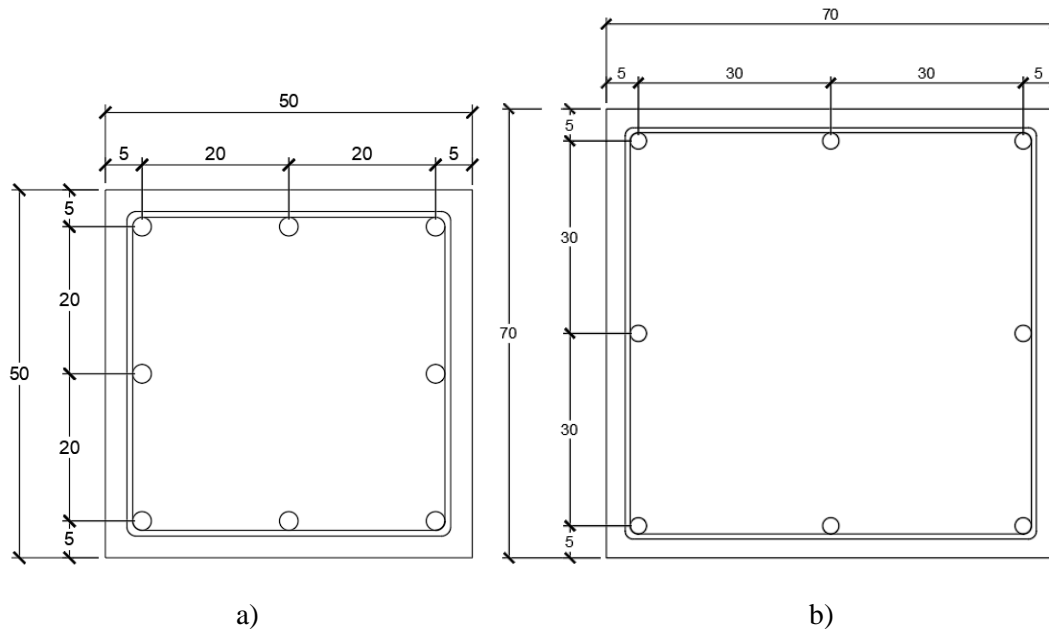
Detalle del armado de columnas para el modelo 2 y 3, cotas en centímetros
